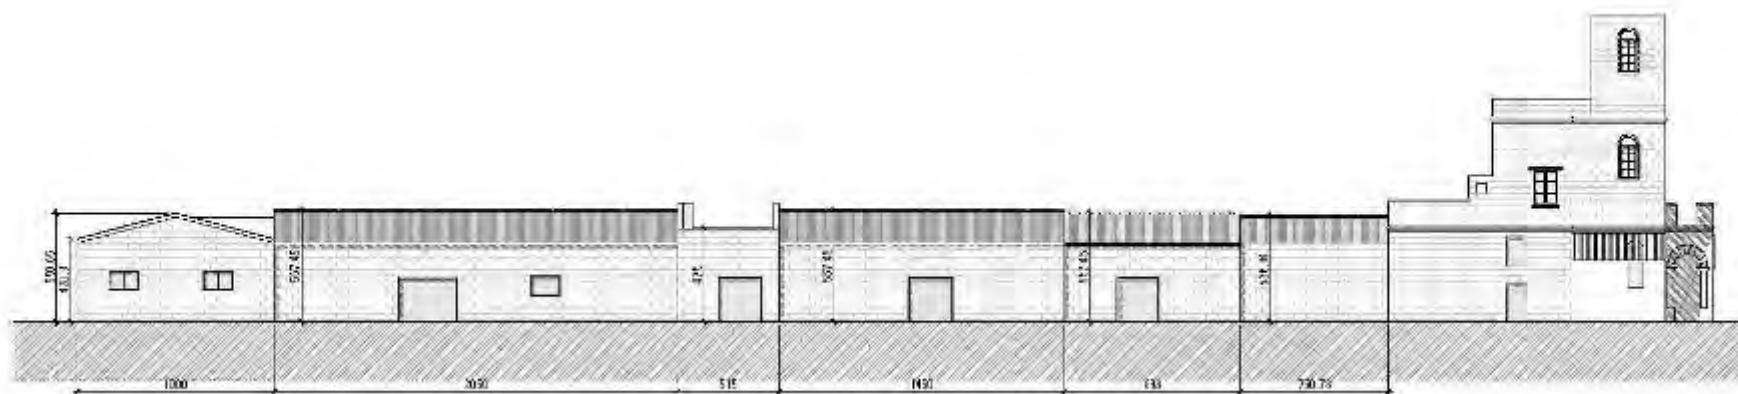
Stato di Fatto - Complesso Curto. Prospetto Est
